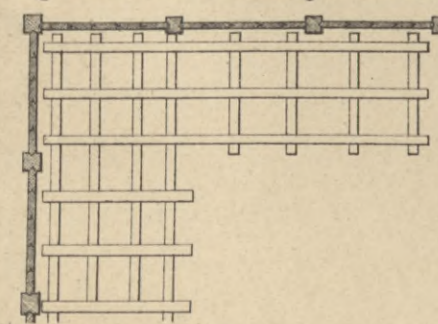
Alma - Brücke in Paris. M. 1:200. A cross-sectional diagram of the Alma Bridge in Paris, showing its pile foundation and stone structure.
